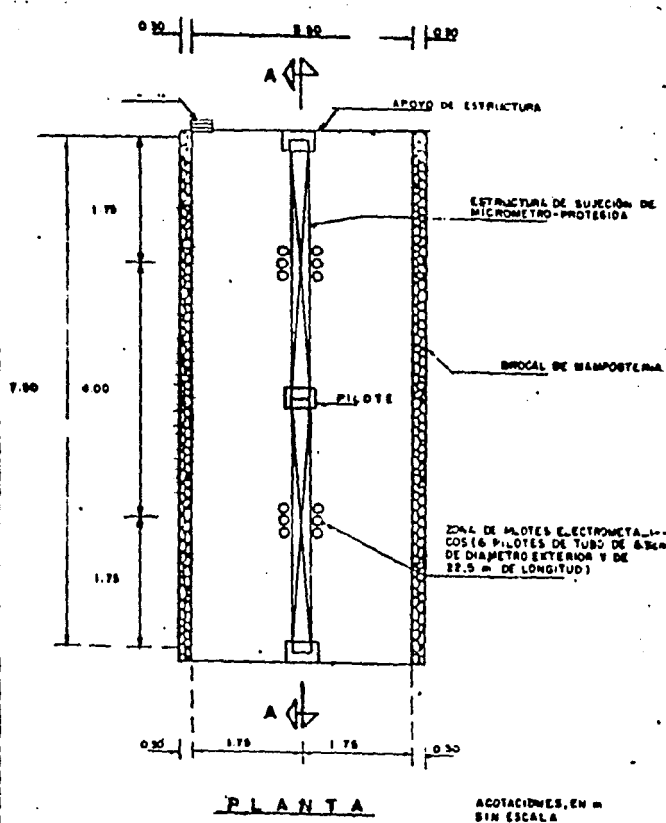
Zona en planta para pruebas de carga con pilotes electromecánicos
